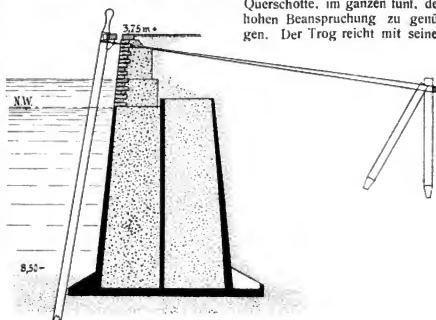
Kaimauerfundierung auf Betoneisentrog.
